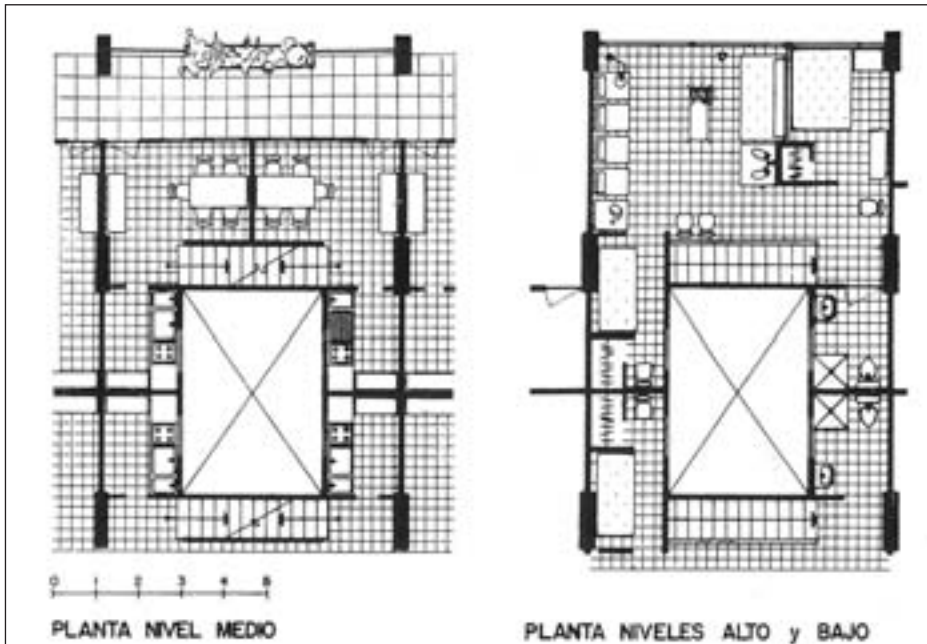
Unidad habitacional Presidente Alemán, 1949-50. Planta de departamento en dos niveles. (Noelle y Pani, 2000).
